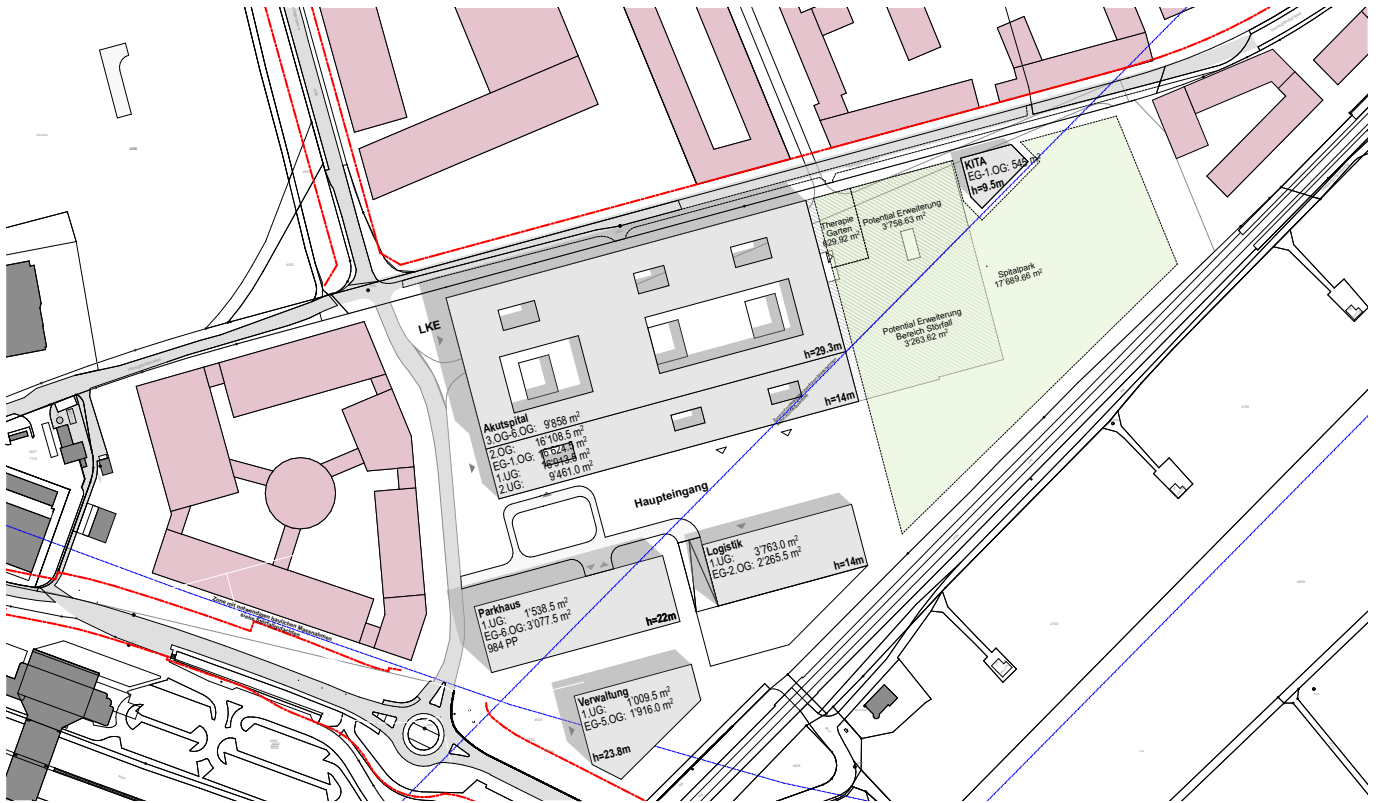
Situationsplan V5, Stand 22.07.2025, freier Massstab, Norden ist oben (metron)
